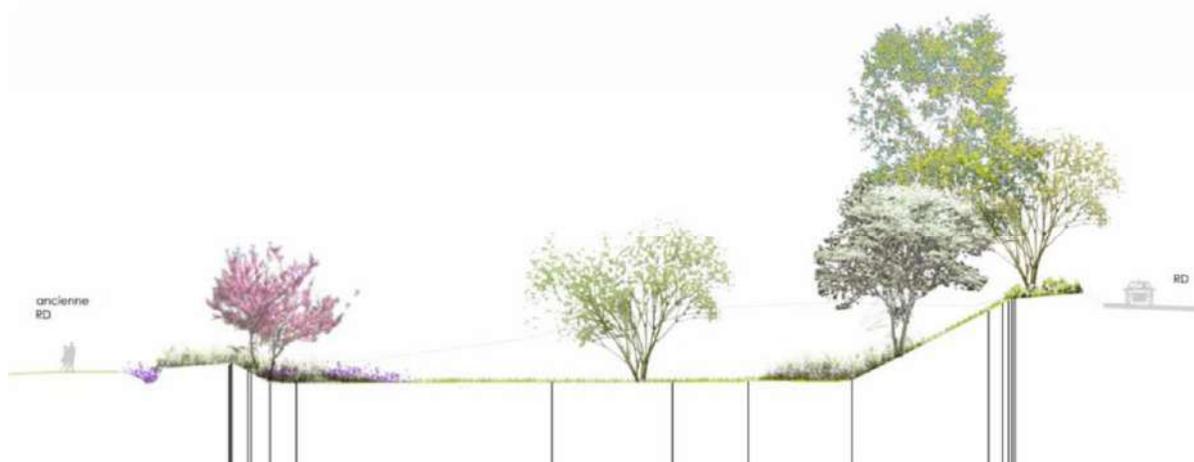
Plan de coupe de principe illustrant la végétalisation du bassin
